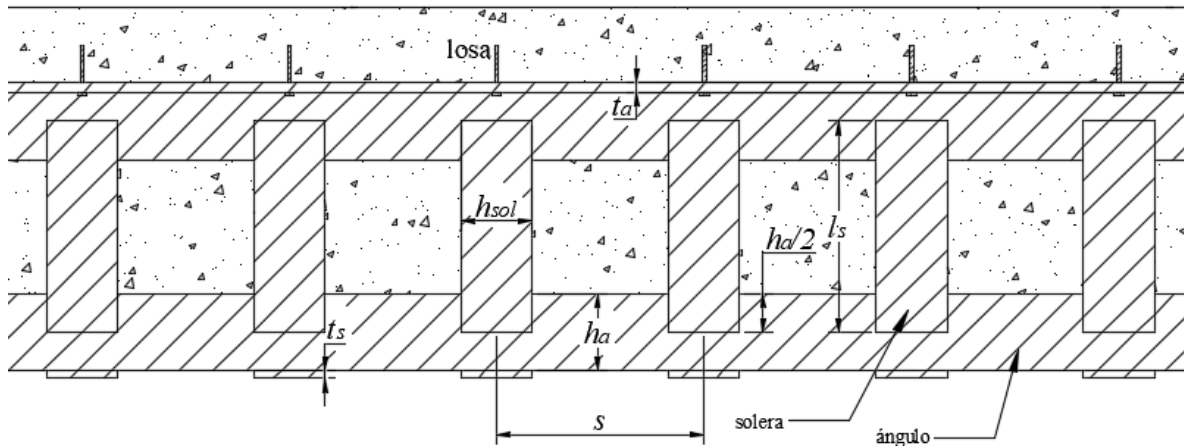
Sección longitudinal de viga encamisada con ángulos y soleras
